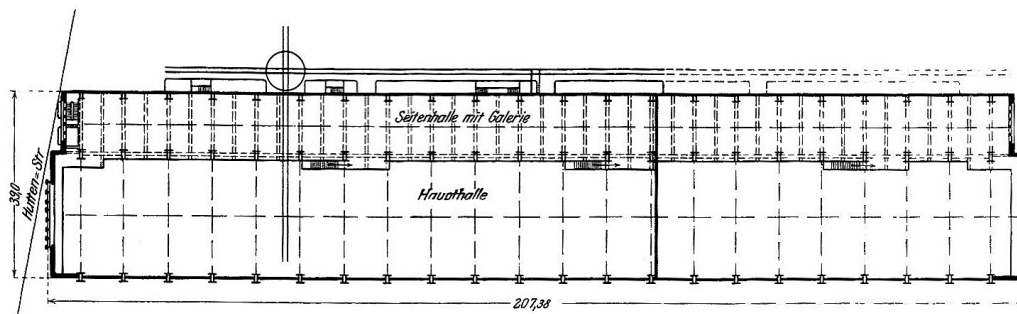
P. Behrens, *AEG Turbinenhalle*, Grundriss EG
